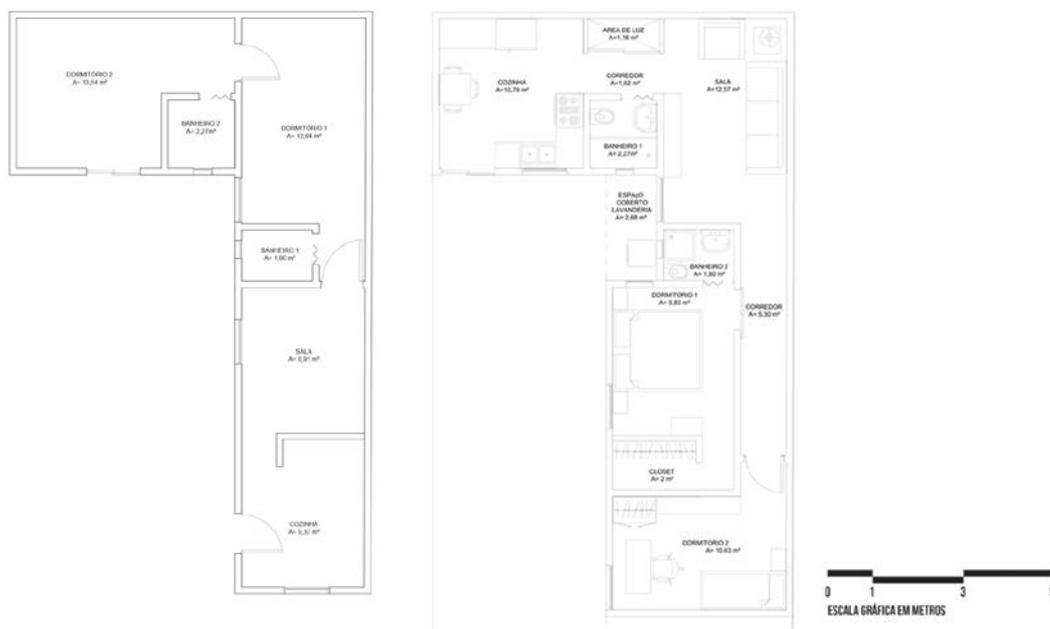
Planta da casa original e do projeto da casa 2. Fonte: Autores (2020).
